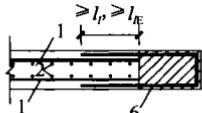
墙体钢筋焊接网的竖向搭接
